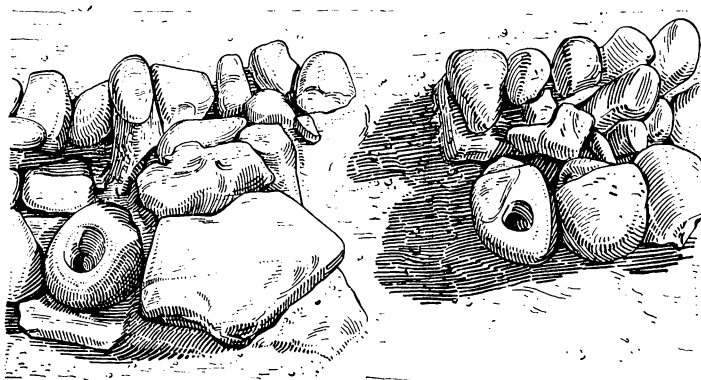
Фундамент стены, камни-подпятники и порог дома
